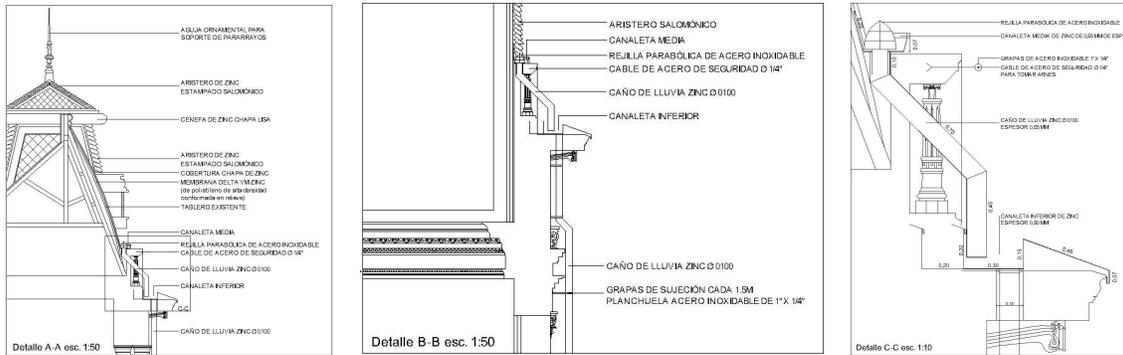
a 42 – Detalles de la cubierta. Proyecto (2007)
